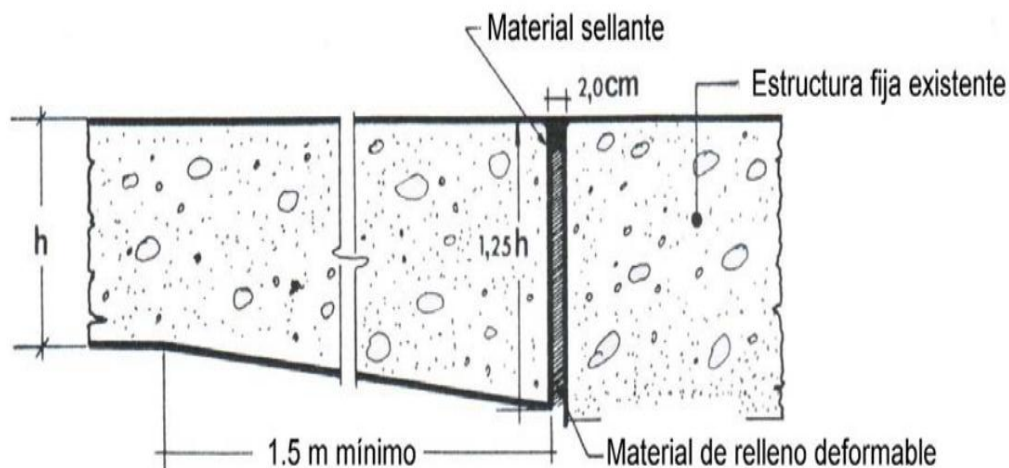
, *Protección de una cámara de inspección con una junta de separación
